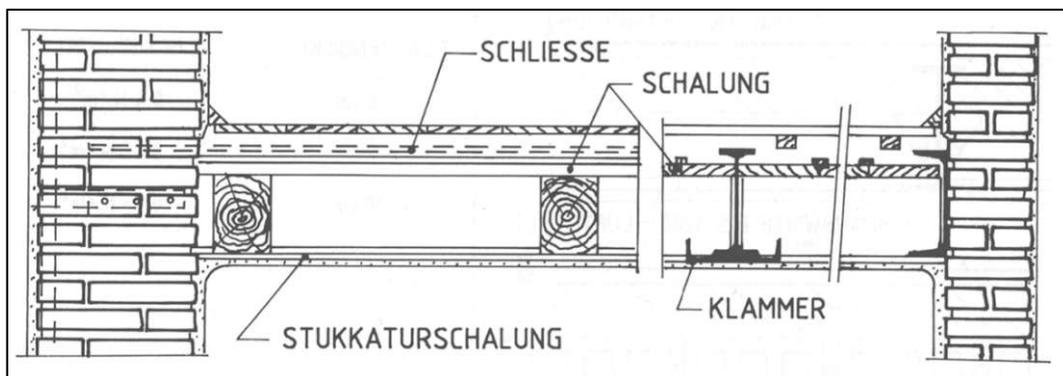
Tramtraversendecke (links: Querschnitt – rechts: Längsschnitt) [76]
